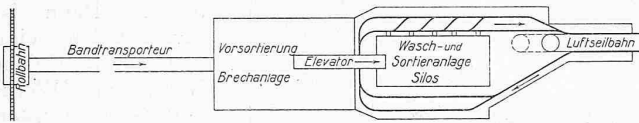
Schematischer Grundriss der Kiesaufbereitungs-Anlage. — 1 : 900.
